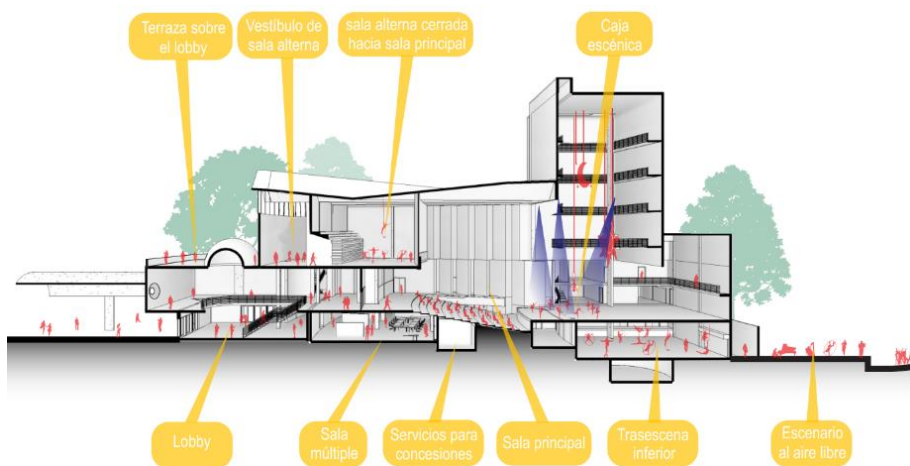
Esquema Corte longitudinal Proyecto – Opción 1 (Sala Dividida en dos)
